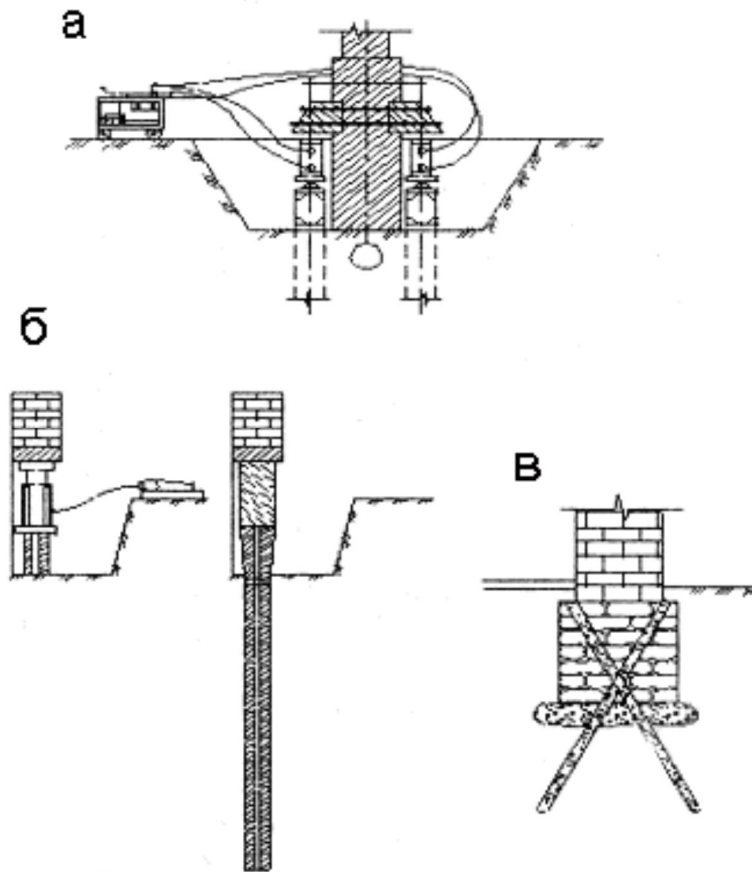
Підсилення фундаментів із застосуванням палей:
